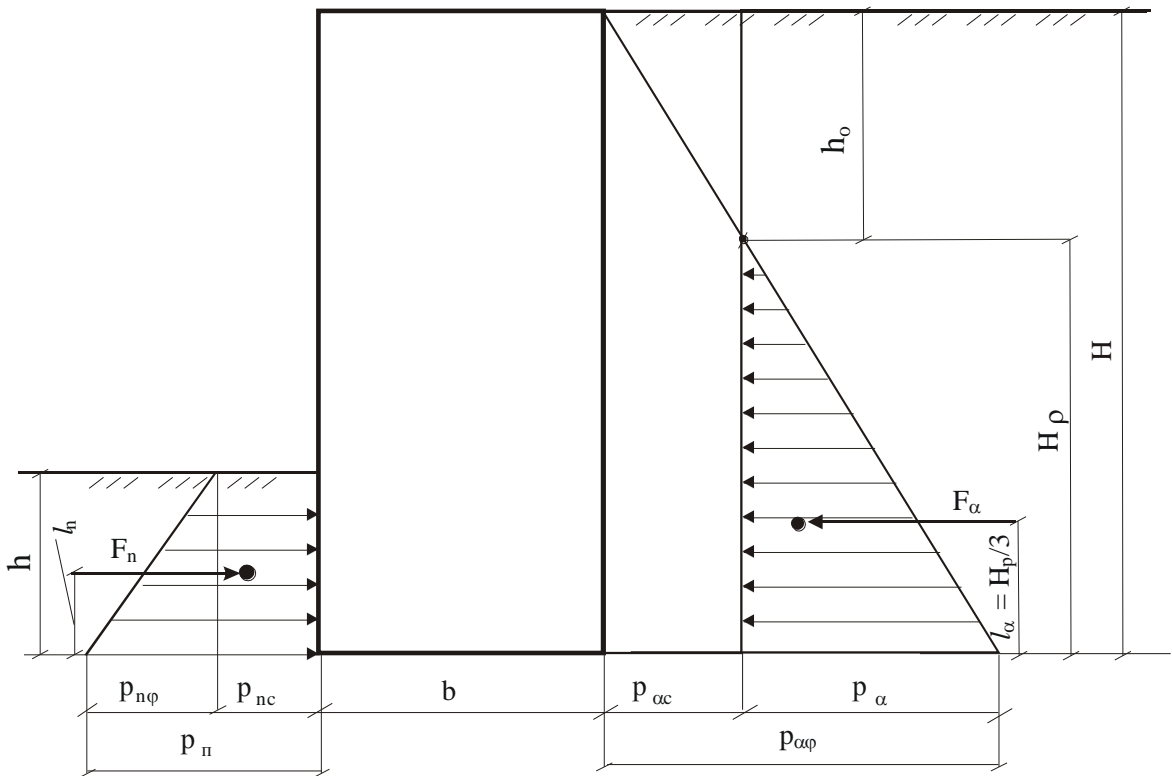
Расчетная схема определения давлений грунта на подпорную стенку
